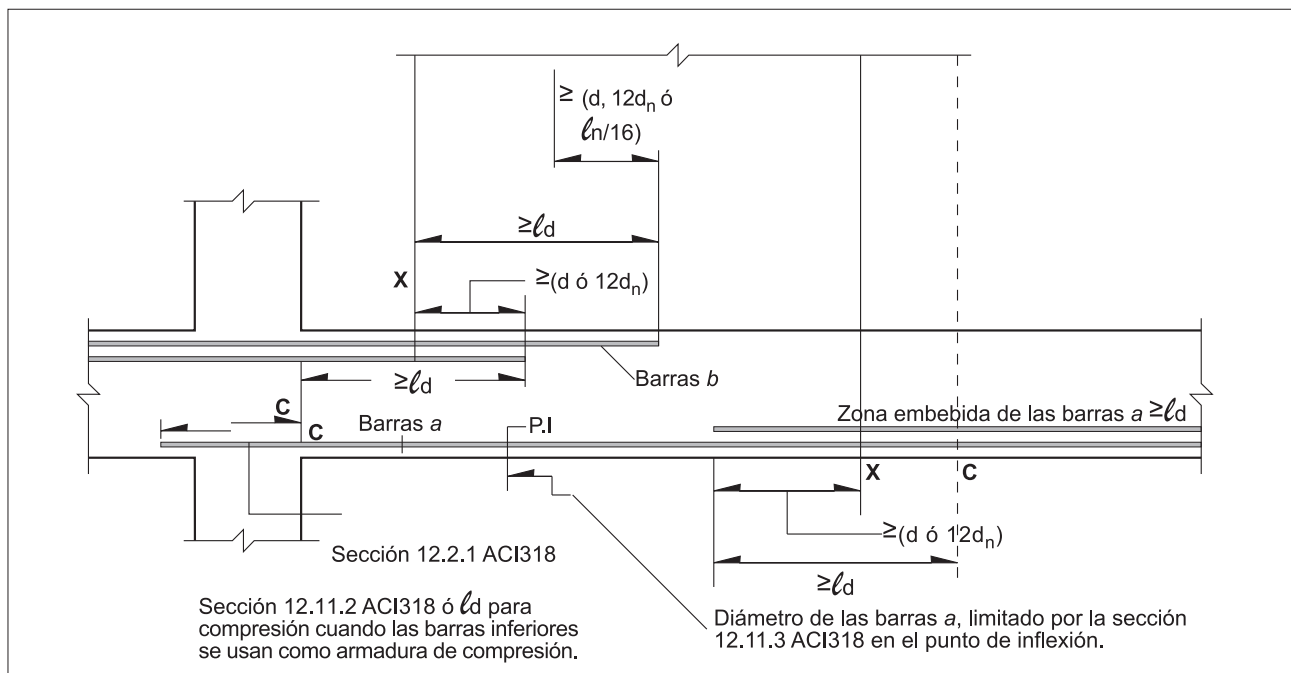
Ejemplo de Armadura por Flexión en una Viga Típica.
